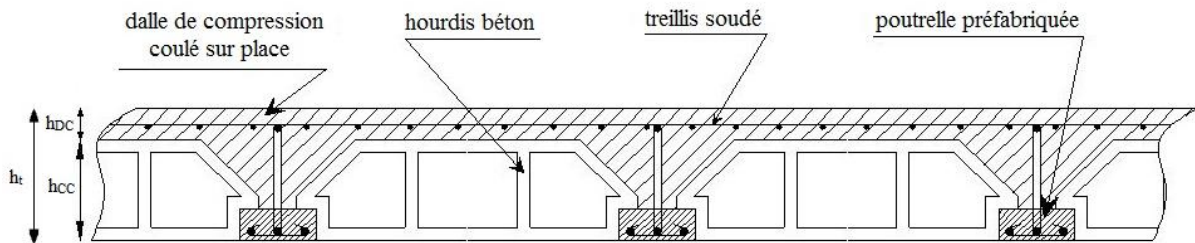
Coupe transversale d'un plancher à corps creux.
